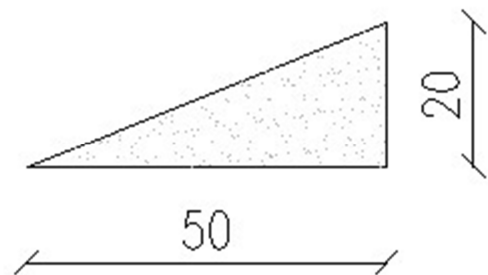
Schema dello scarico dei pesi della muratura sugli archi e sulle spalle della cella campanaria.
